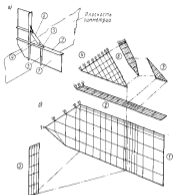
Разбивка узла квадратной конструкции на супер-узлы: а — общий вид узла; б — суперэлементы узла.
